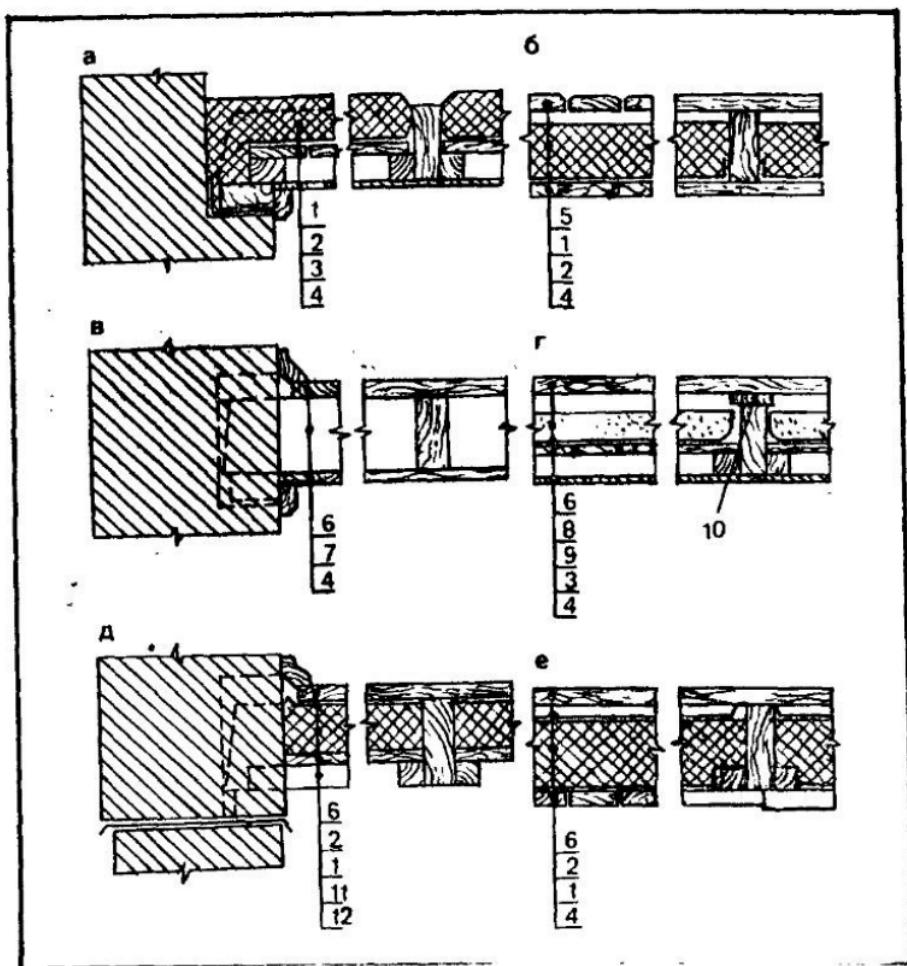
Фрагменты перекрытий по деревянным балкам:
